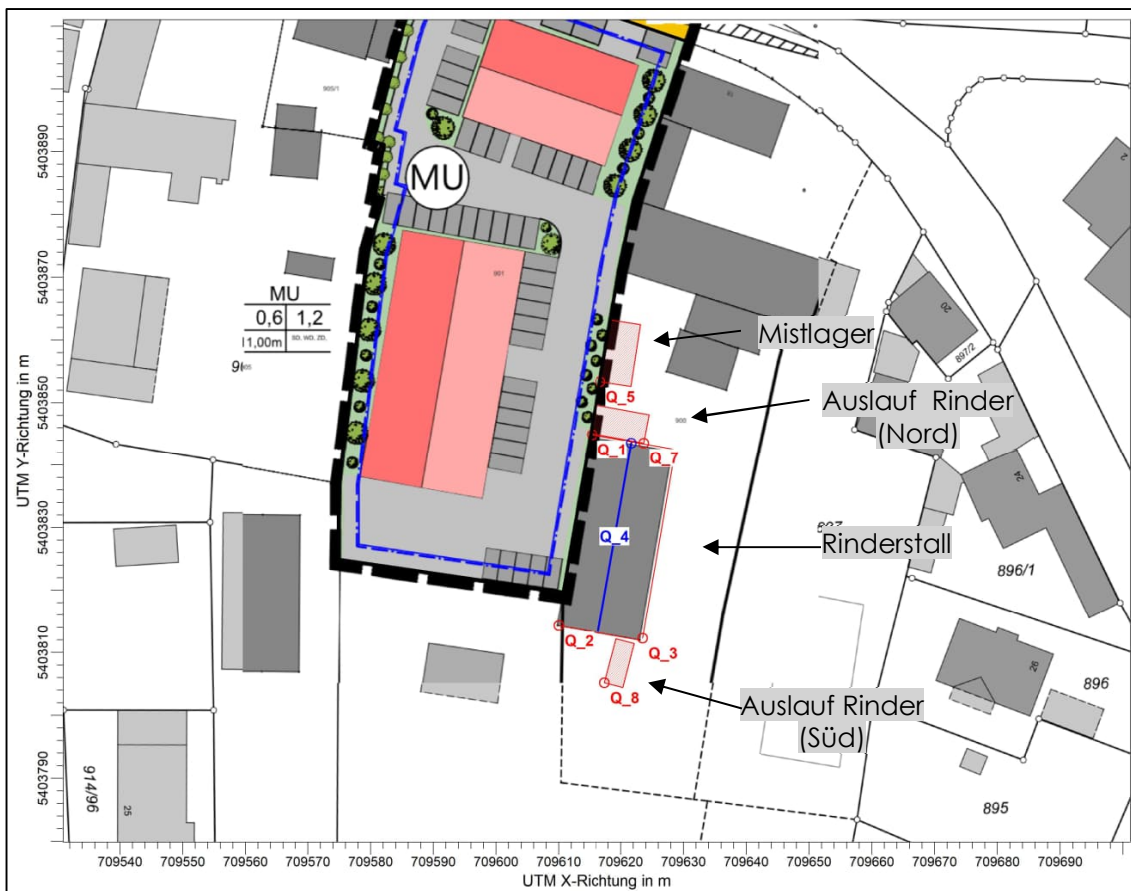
Lageplan mit Darstellung der Emissionsquellen und dem geplanten Geltungsbereich
